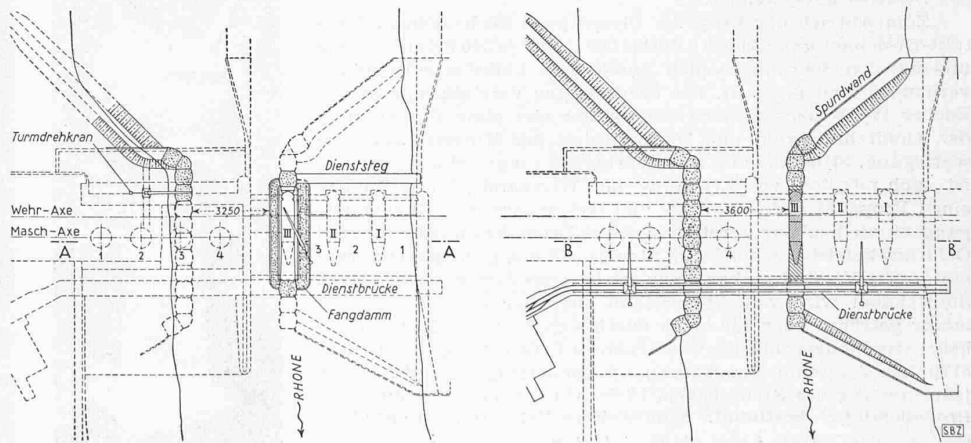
Erste Phase, 1. Etappe Grundrisse 1 : 3000 der Installation für Wehrbau und Maschinenhaus-Ende
